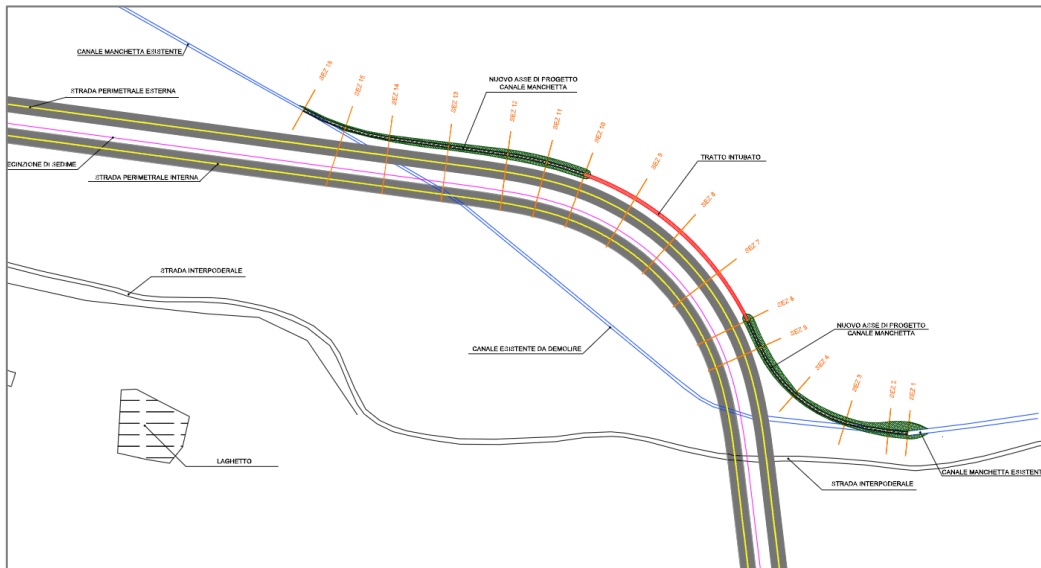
Planimetria Canale Manchetta Progetto esecutivo di prolungamento della pista di volo THR 28
